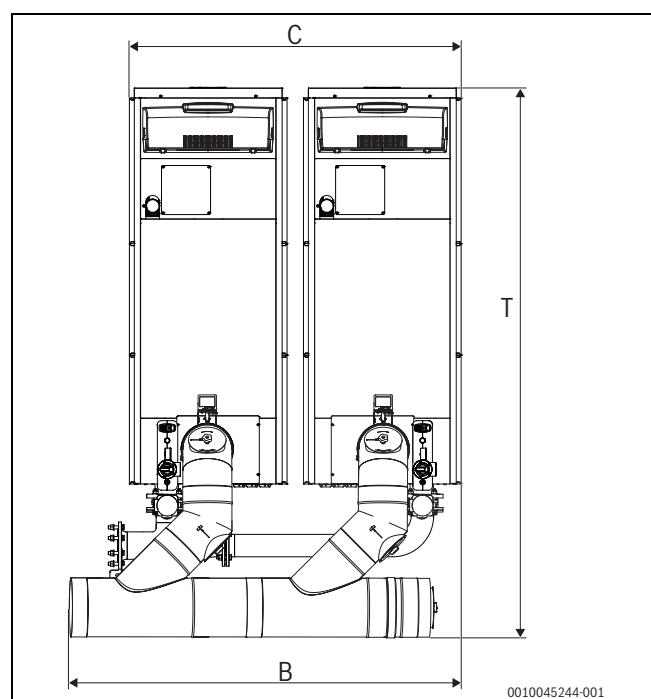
2-Kessel-Kaskade über dem Kessel (Draufsicht)
